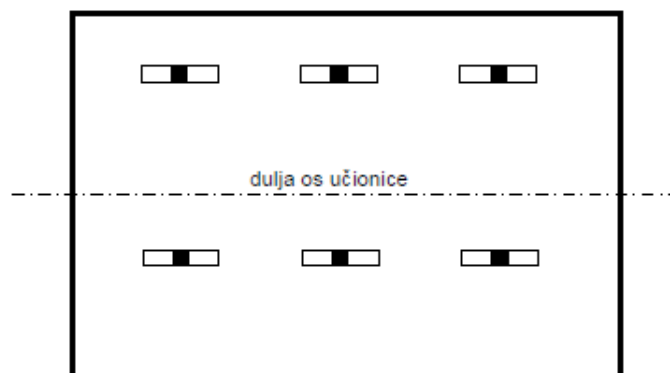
Pravilan razmještaj rasvjetne armature [1]
